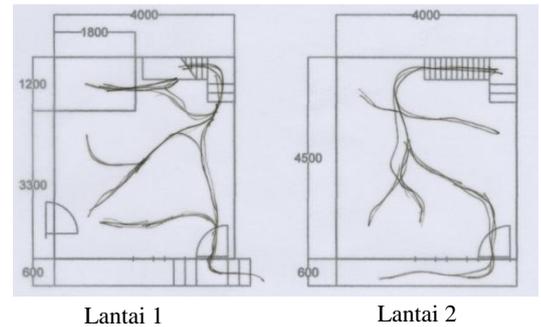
Denah lantai 1 rumah mbak Hn
